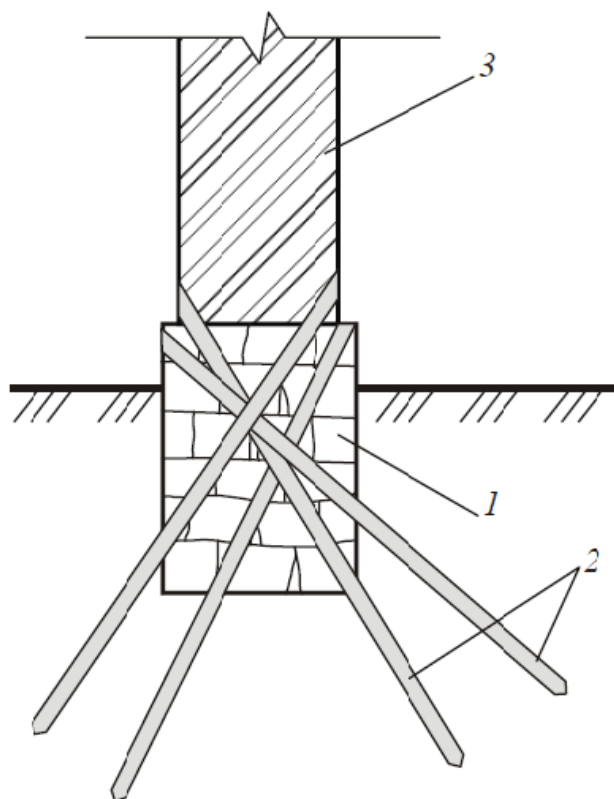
Усиление фундаментов буро-инъекционными сваями: 1- фундамент; 2- буроинъекционные сваи; 3-стена
